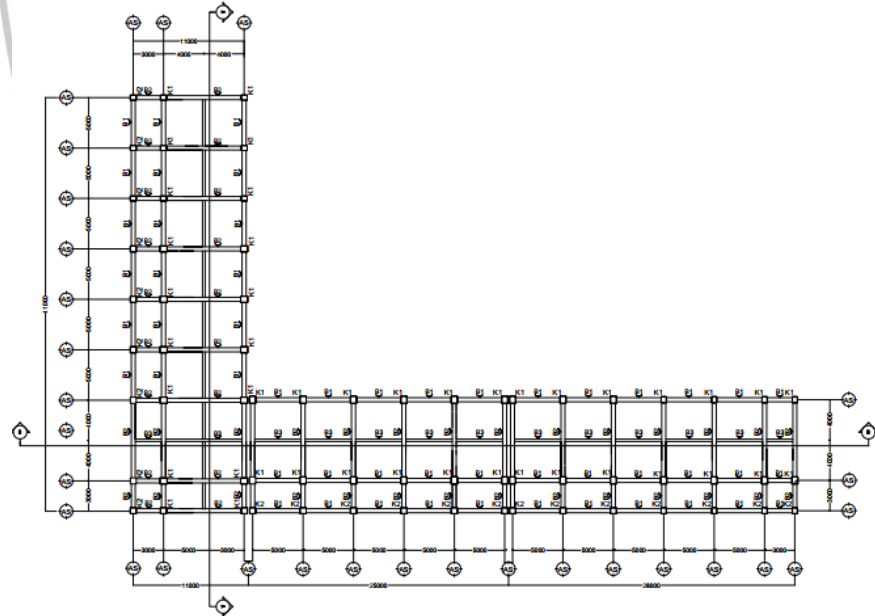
Rencana Balok dan Kolom Lantai 2
